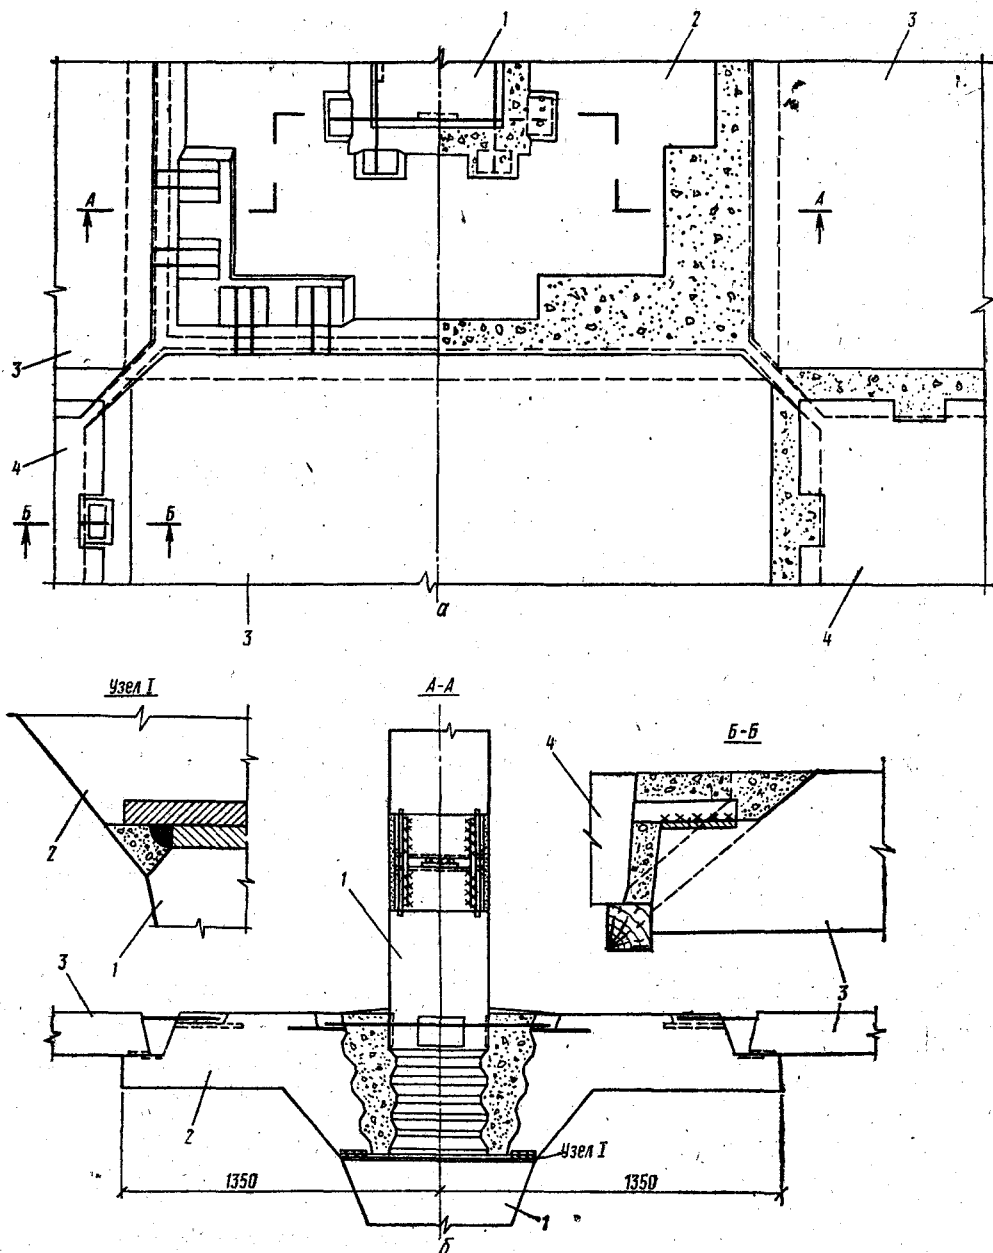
Сборные железобетонные безбалочные конструкции серии 1.420-4:
